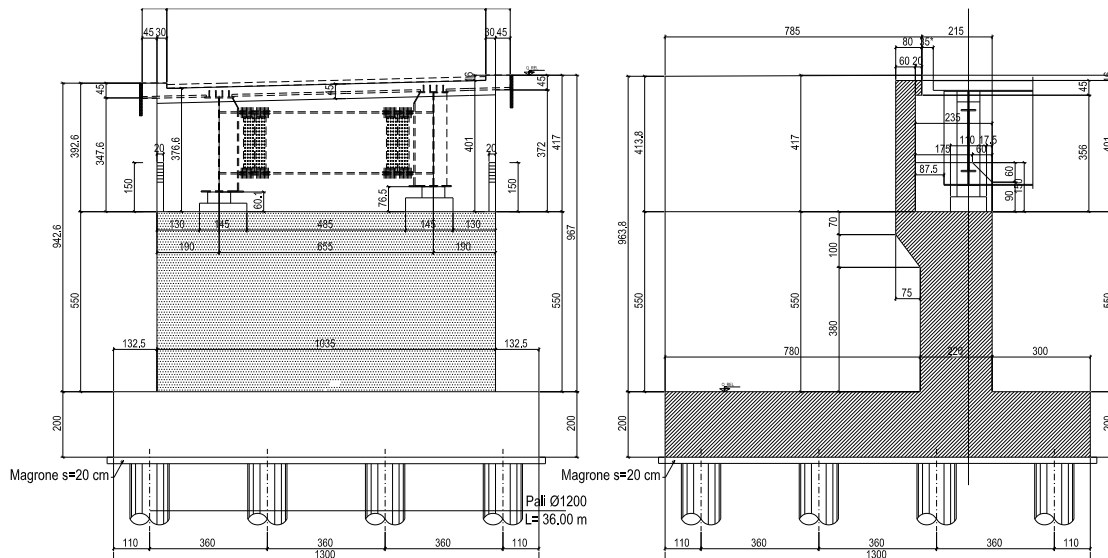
Vista frontale e sezione longitudinale spalle SP1
